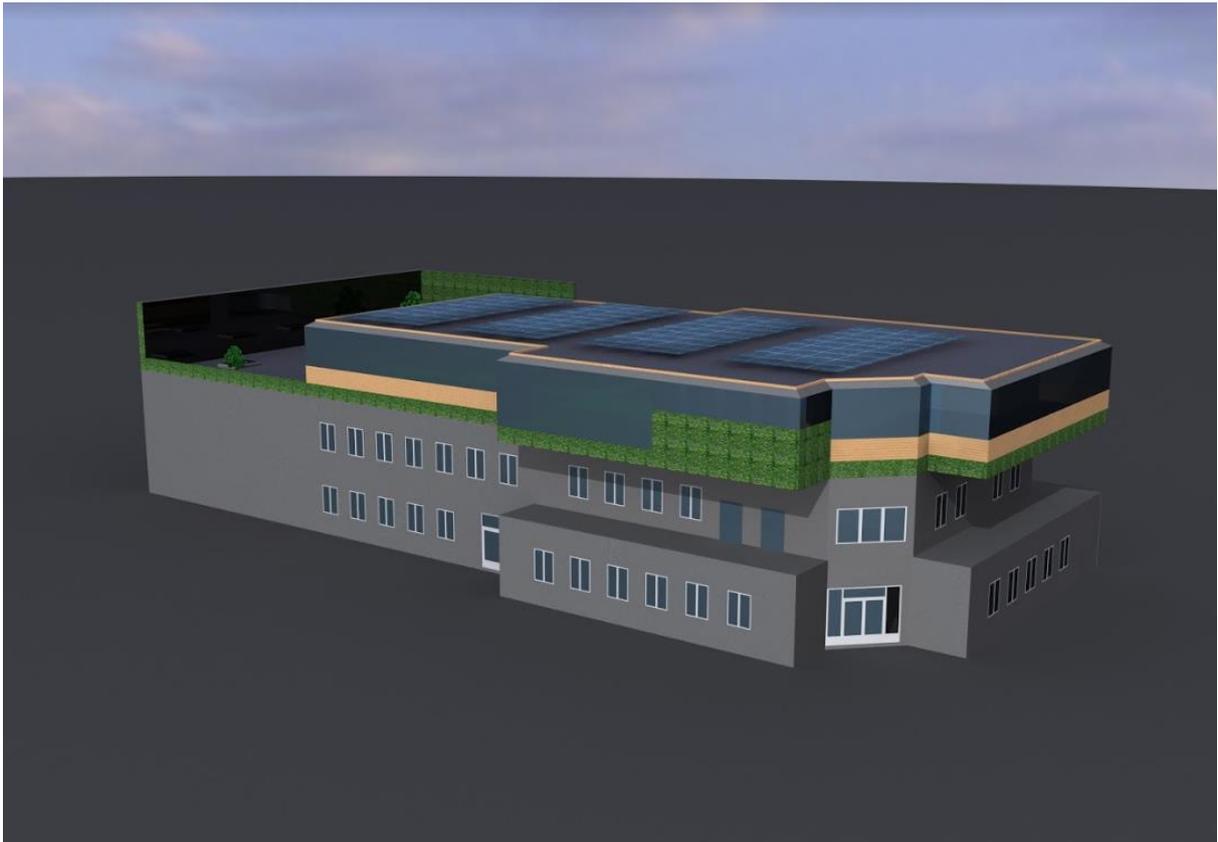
Haupthauses plus Fassadengestaltung in Farbgebung und Holz mit Fassadenanimation Rendering
